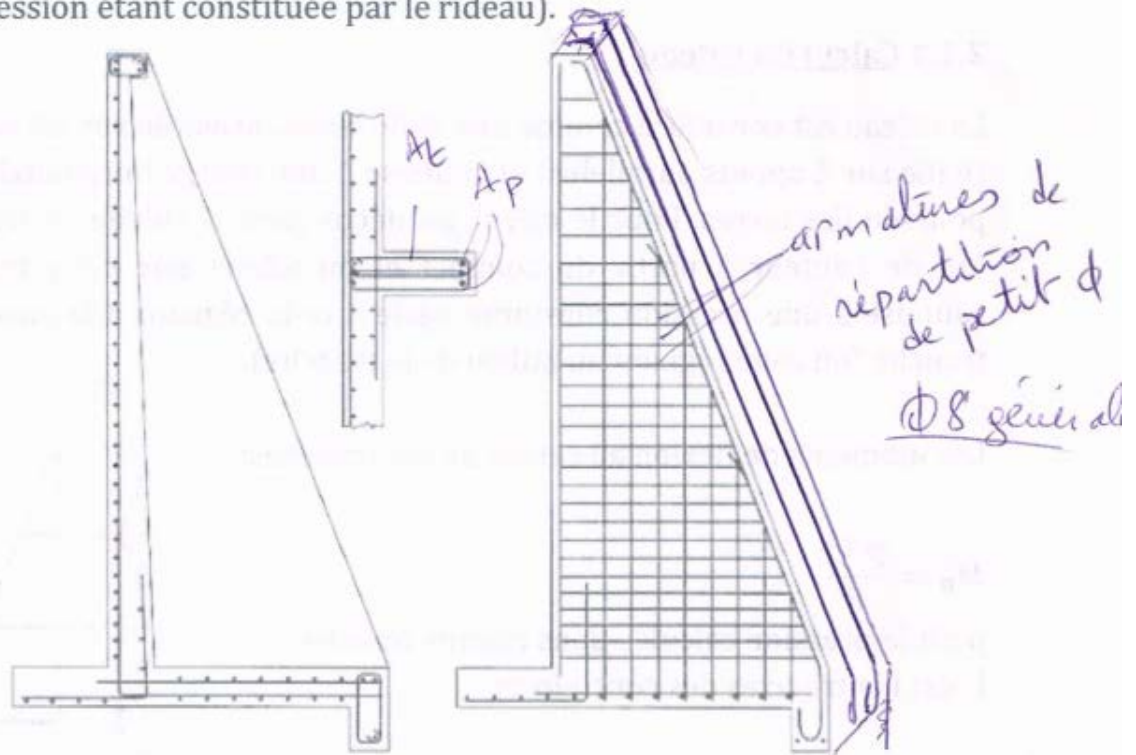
Exemple de Schéma de ferrailage des murs à contrefort
